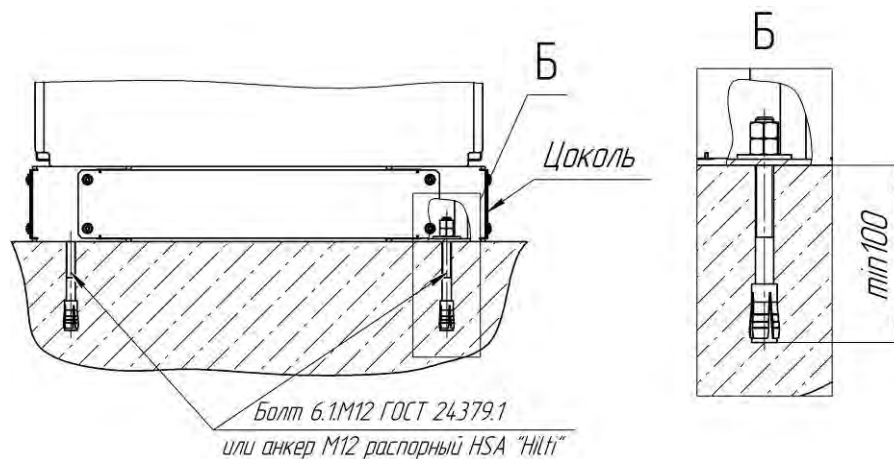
Вариант крепления ГРЩ с помощью анкерных болтов
